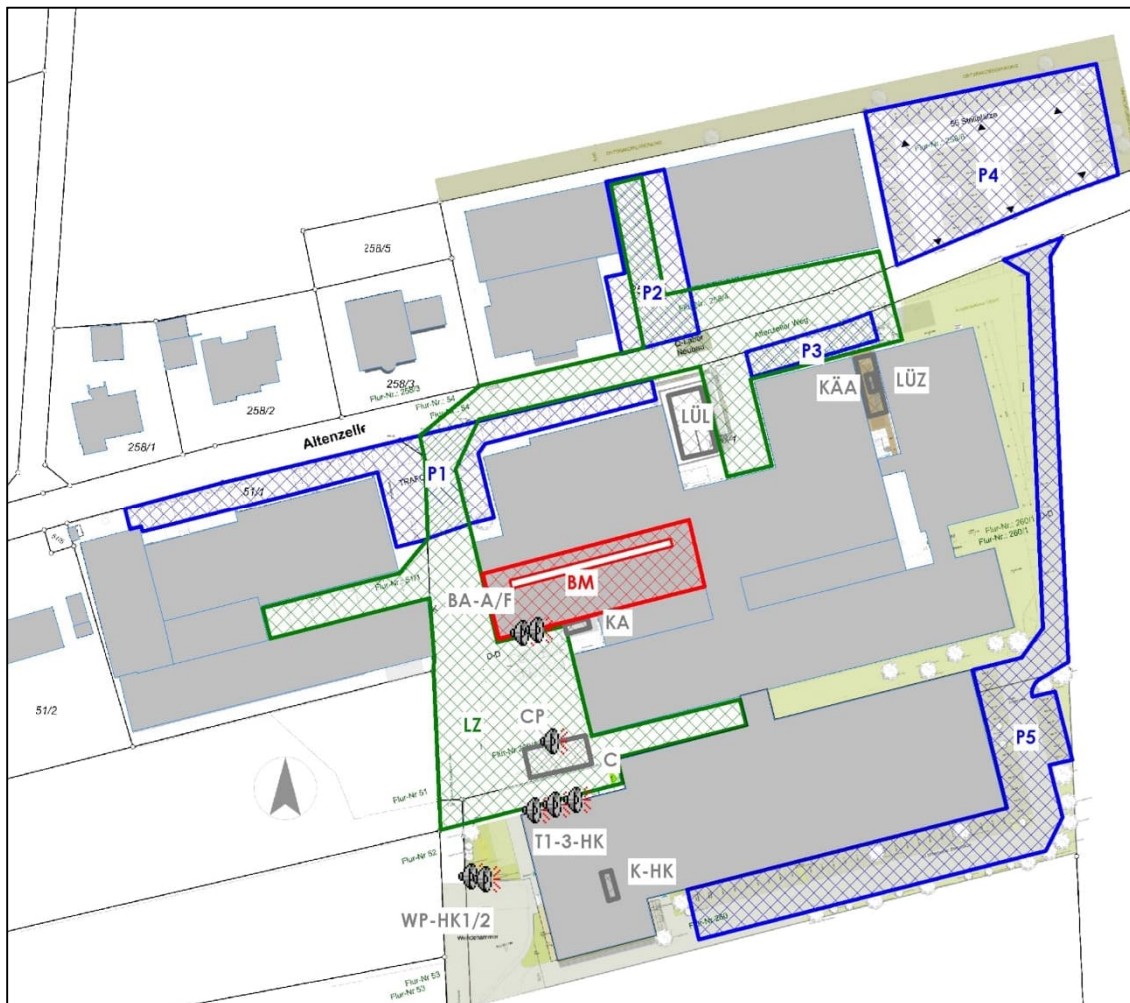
Lageplan mit Darstellung der relevanten Schallquellen
